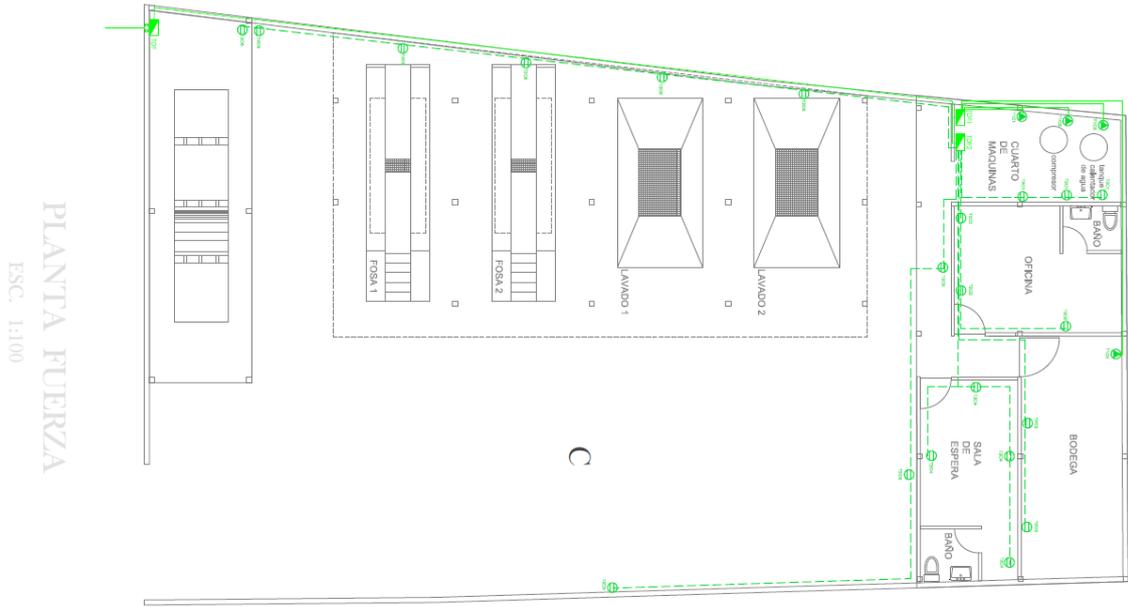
Plano de planta de fuerza, descripción de las instalaciones eléctricas del centro de auto lavado.
